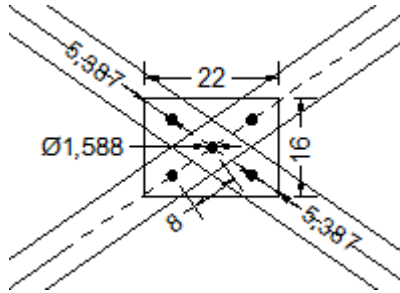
Detalle de conexión apernada entre diagonales verticales y placa metálica
